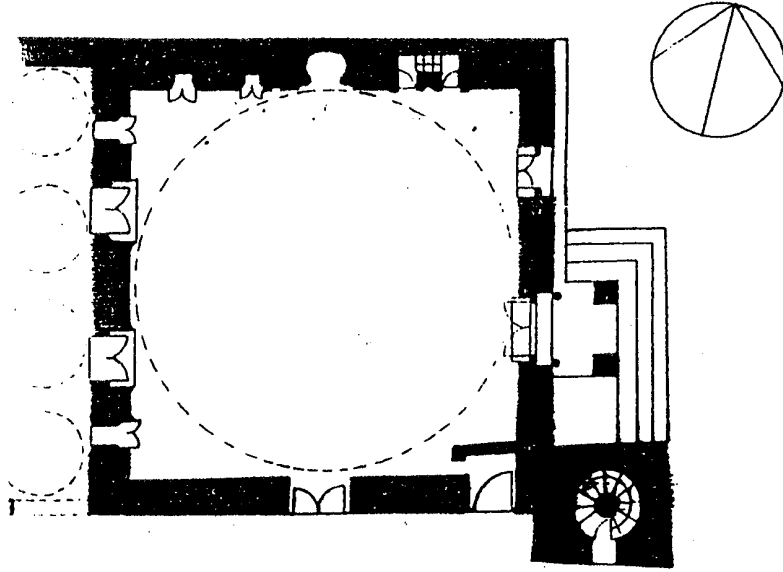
مسقط أفقي لجامع خسرو باشا ضمن مجمعه بحلب
